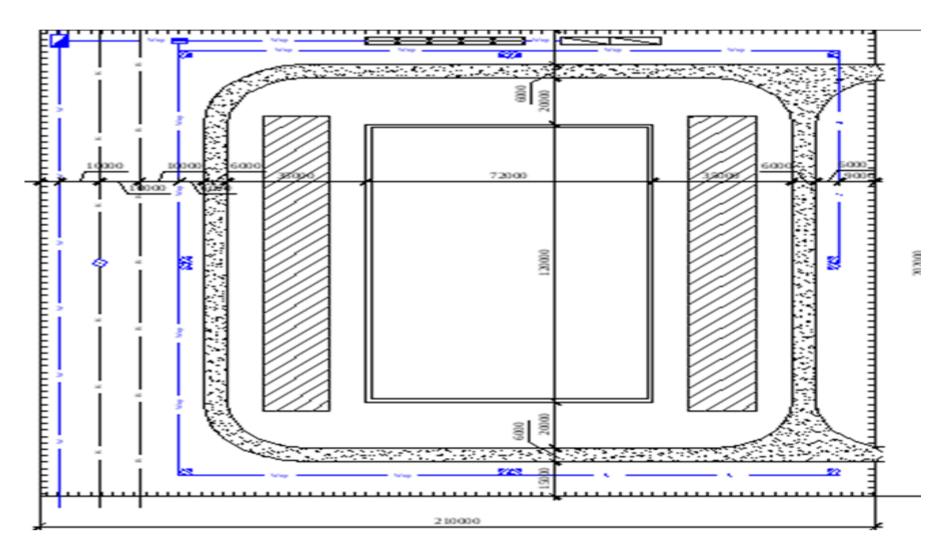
План производства работ на строительной площадке ООО «Пермнефтестрой»
